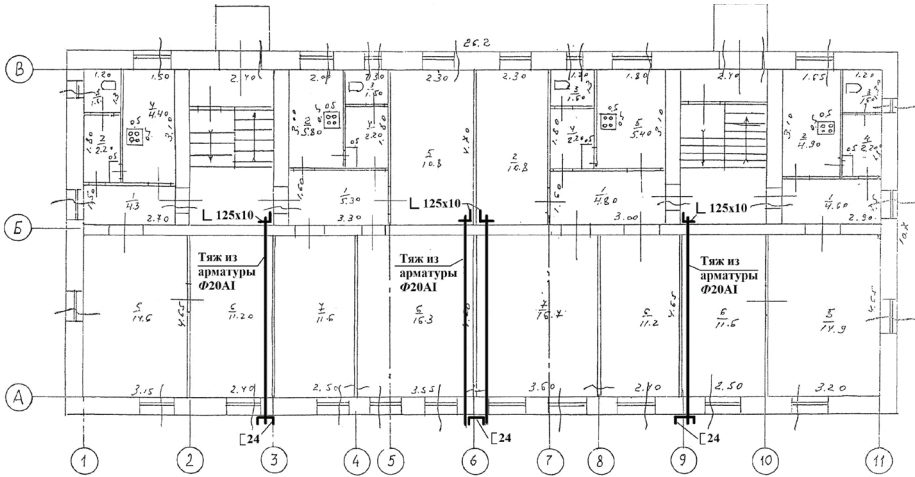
План 1-го этажа. Схема расположения трещин в стенах здания (составлена подрядчиком)
